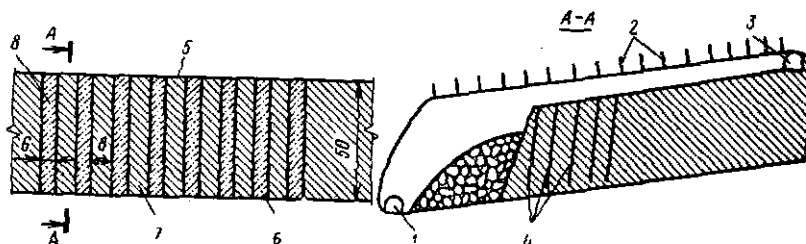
Камерная система с двухстадийной выемкой и твердеющей закладкой: 1 и 3 — соответственно откаточный и закладочный штреки; 2 — анкерная крепь; 4 — взрывные скважины; 5 — висячий бок; 6 — лежащий бок; 7 — камера; 8 — бетонный целик
